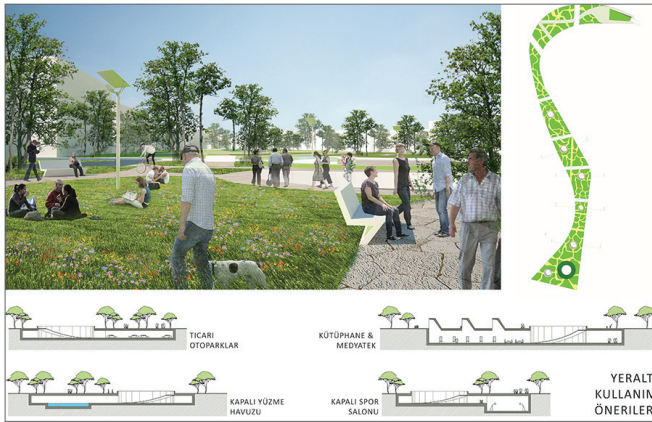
Gaziantep Belediye Çalıştay sonucu sunulan öneriye ait Vaziyet Planı⁴²
